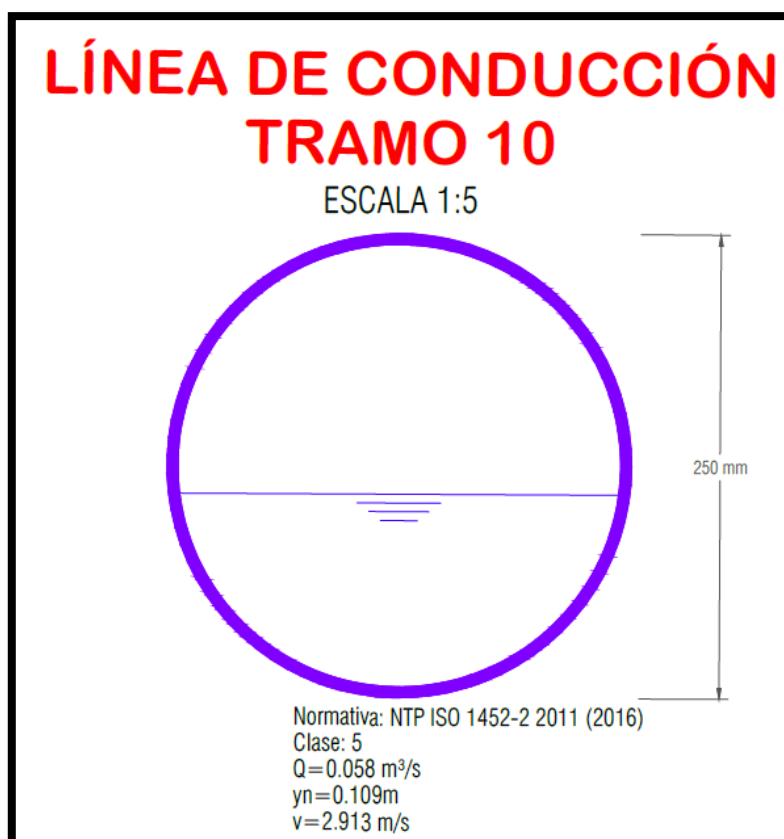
Sección típica de la tubería de PVC-U 250 mm, Tramo 10
